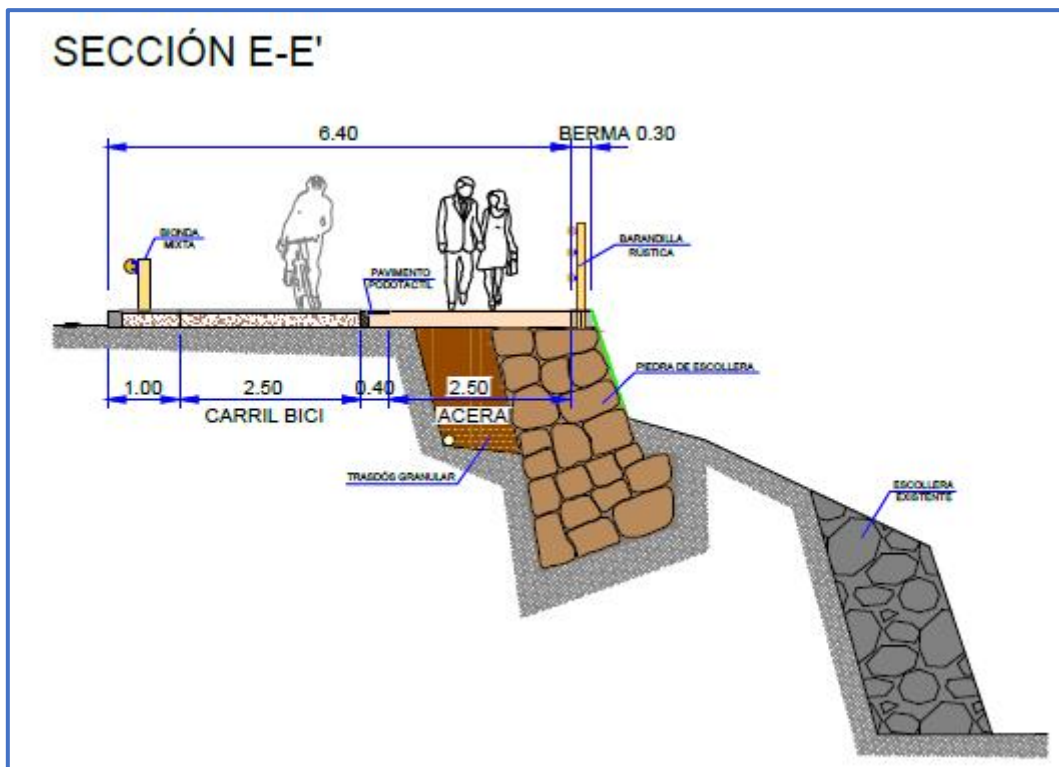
Sección transversal con bionda mixta y berma para alojamiento de alumbrado y barrera rústica.
